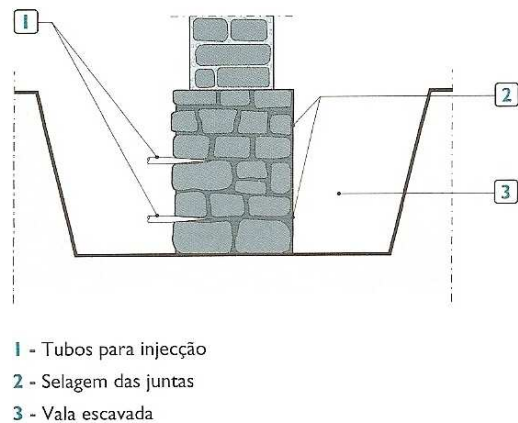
Injeção em fundações de alvenaria, (Fonte [31])
